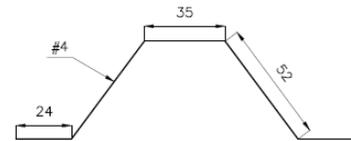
Detalle de trapecio para espacios de apoyo para vigas cerrojo.
